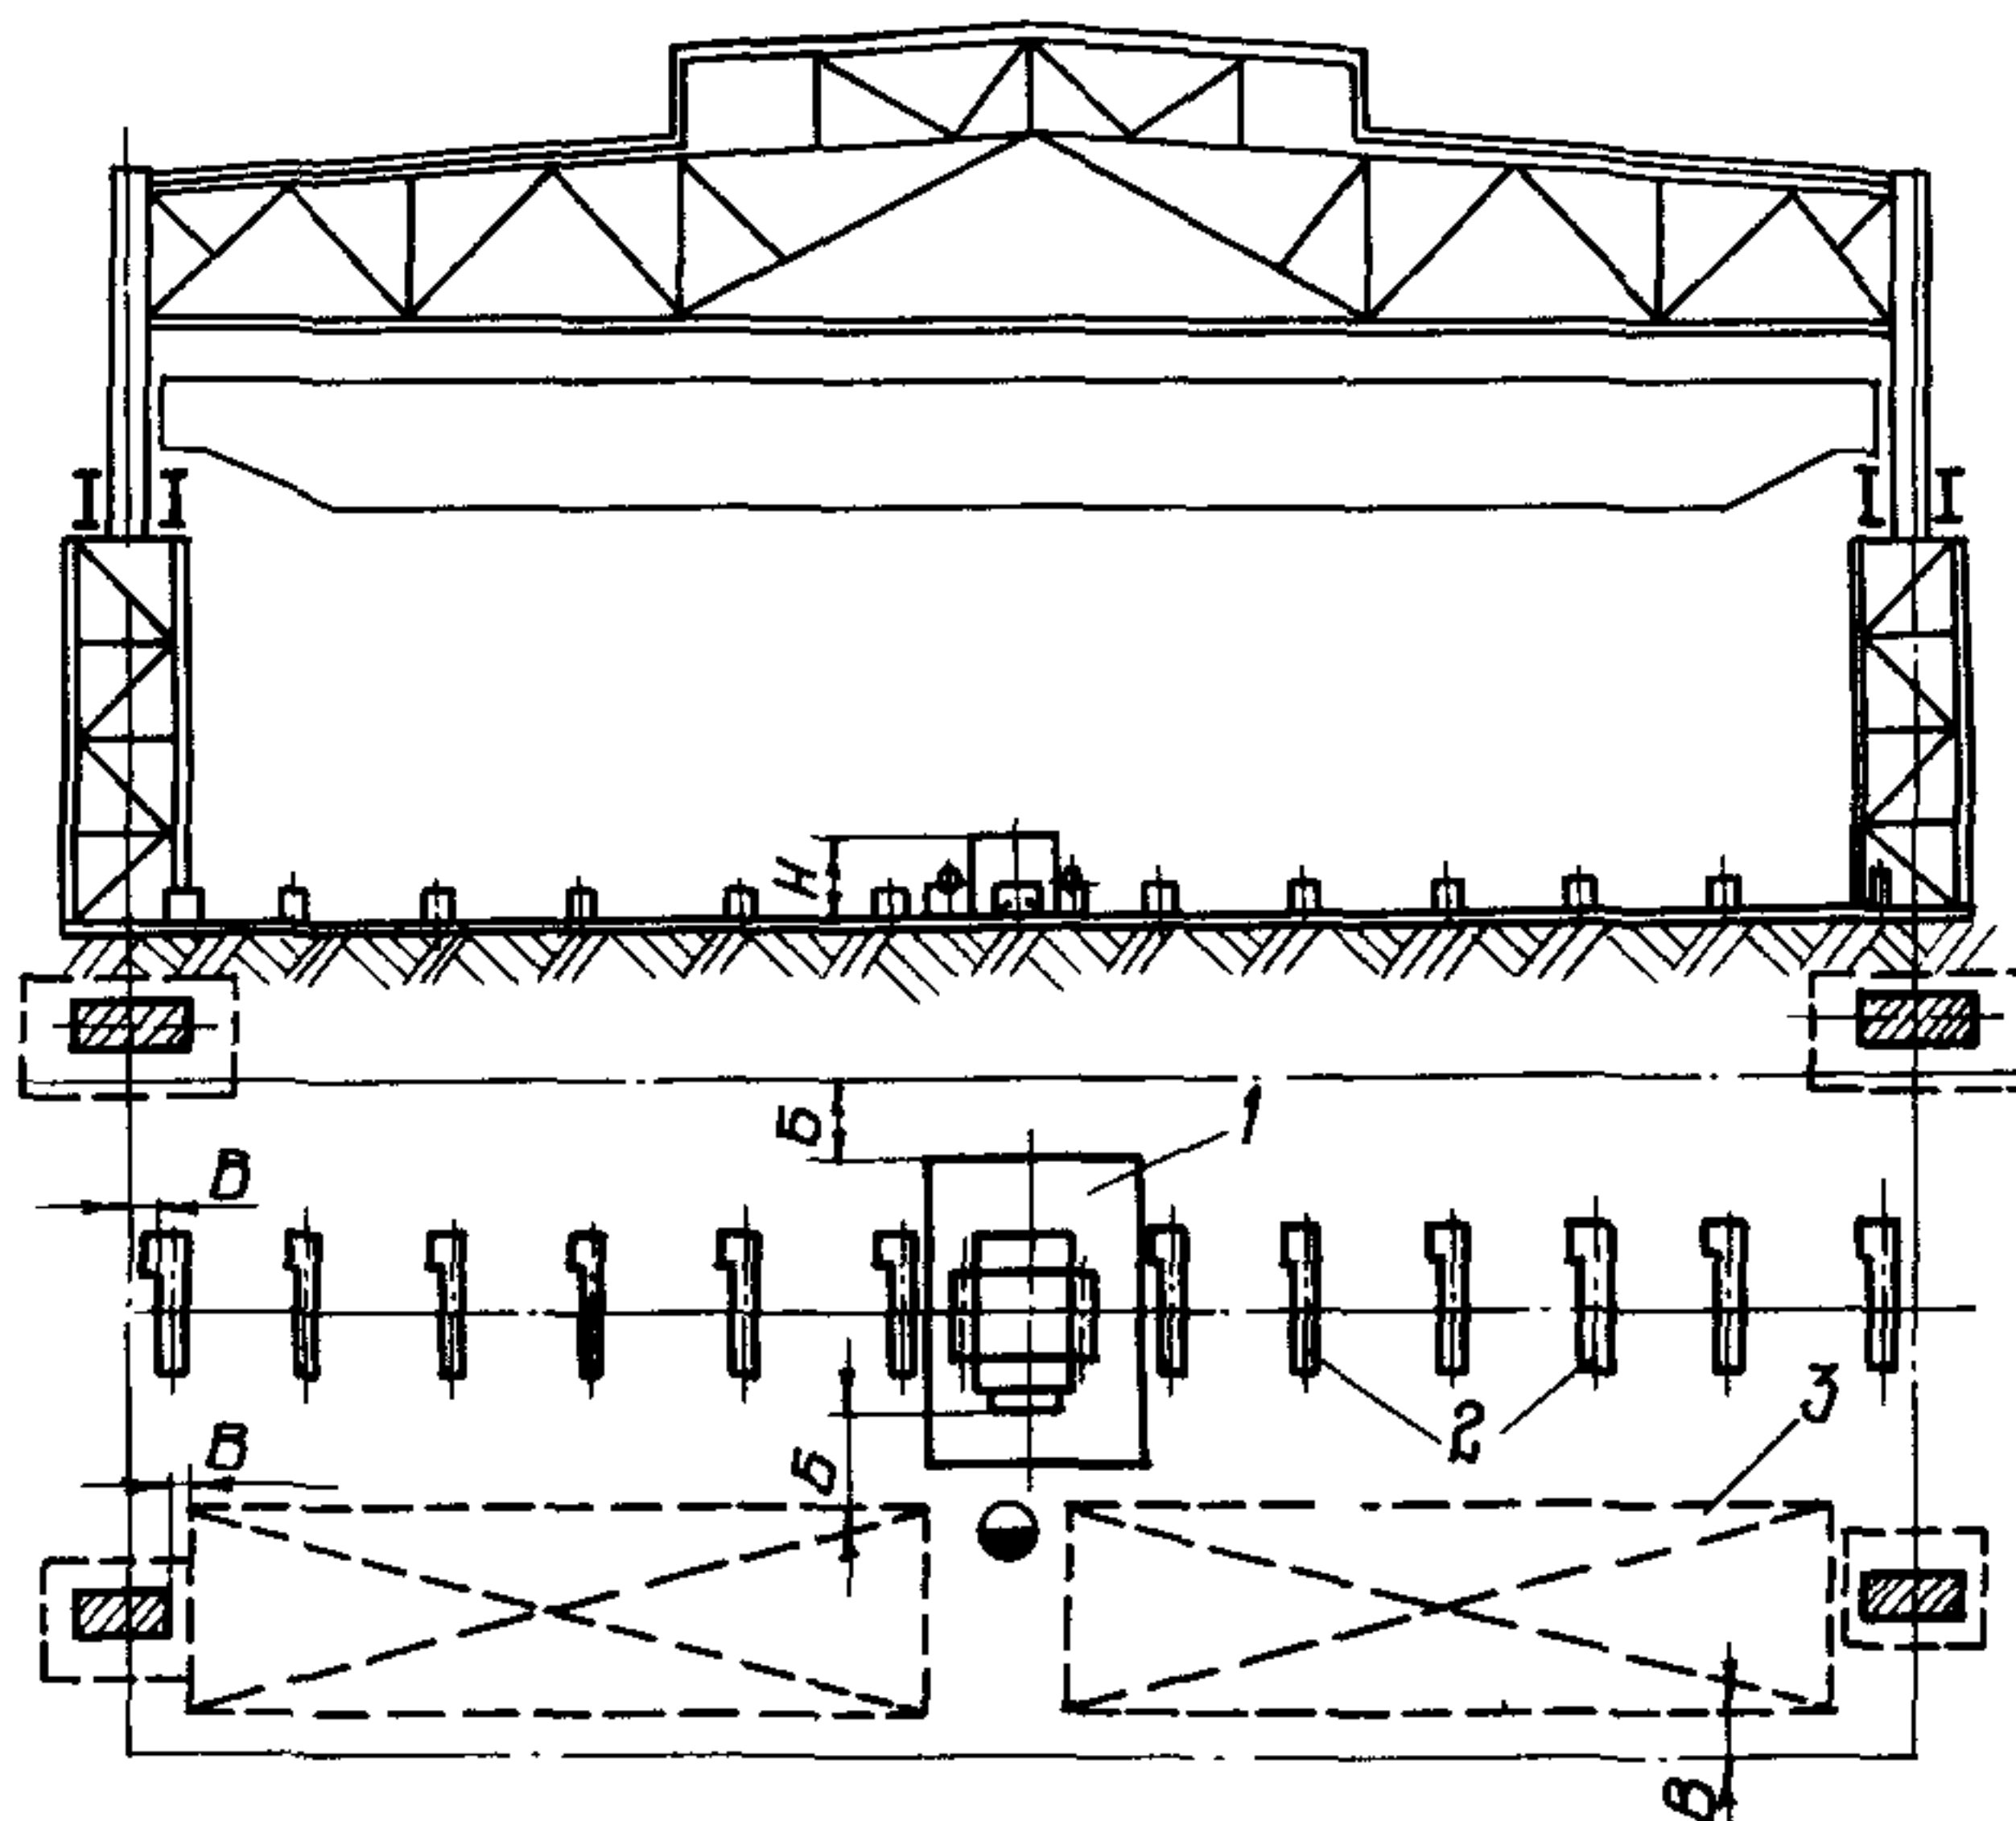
Размещение машины для правки гребовидности сварных двутавровых балок в поперечном пролете:
